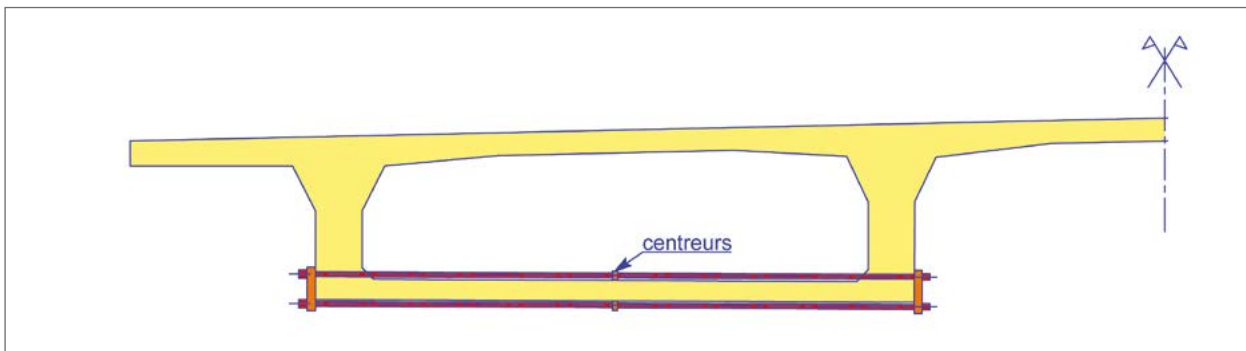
Précontrainte transversale verticale additionnelle par barres disposées à l'intérieur de la structure
